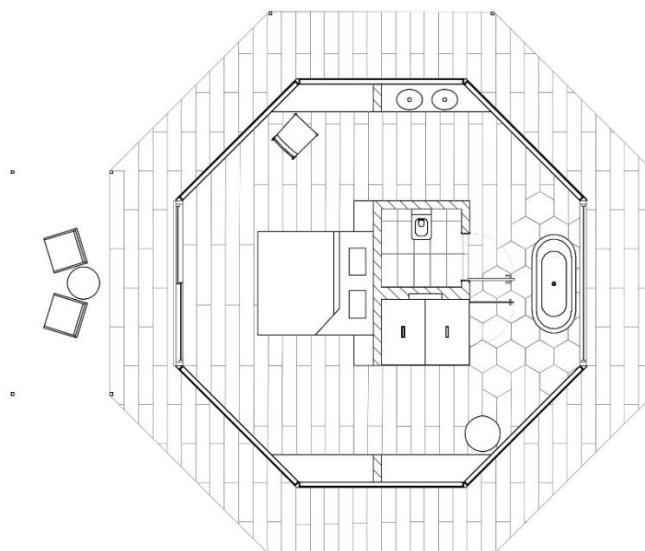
Planta proposta da tenda de Glamping; Fonte: Autores.
